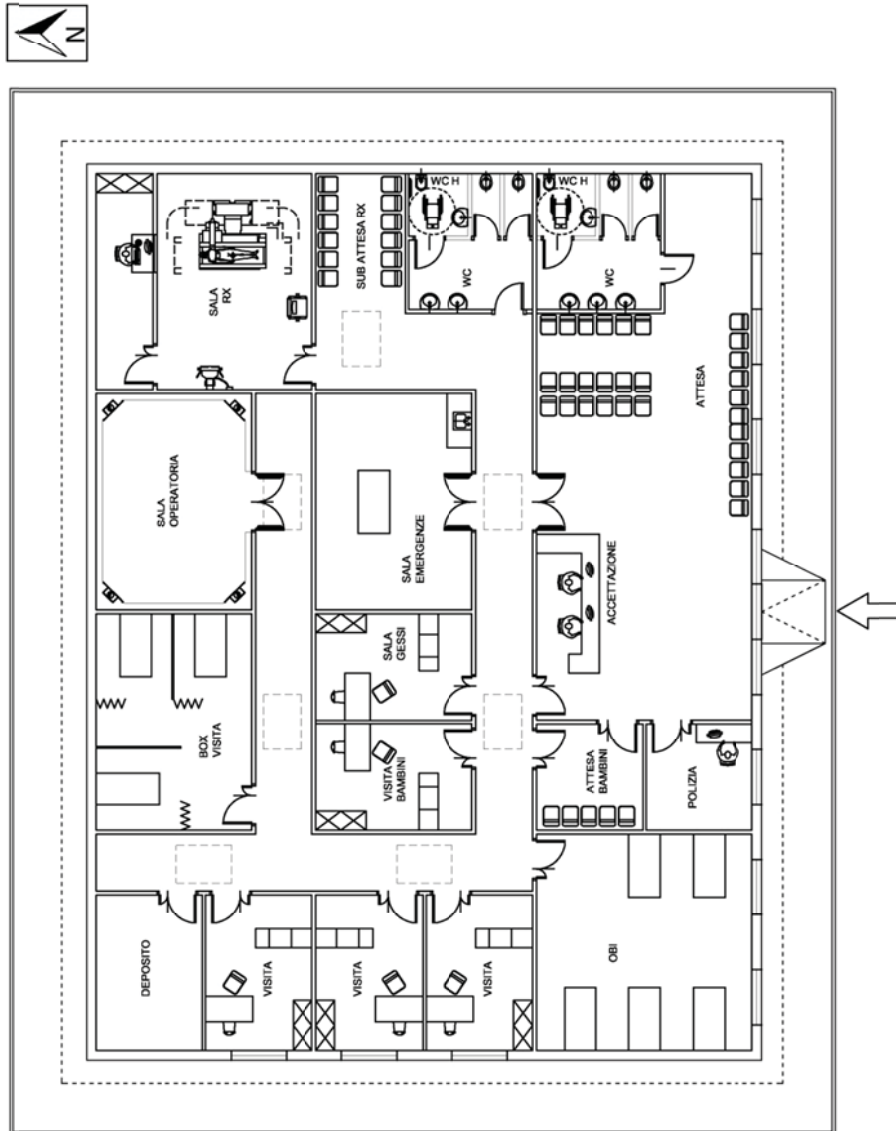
Planimetria del pronto soccorso a 12 moduli versione b
